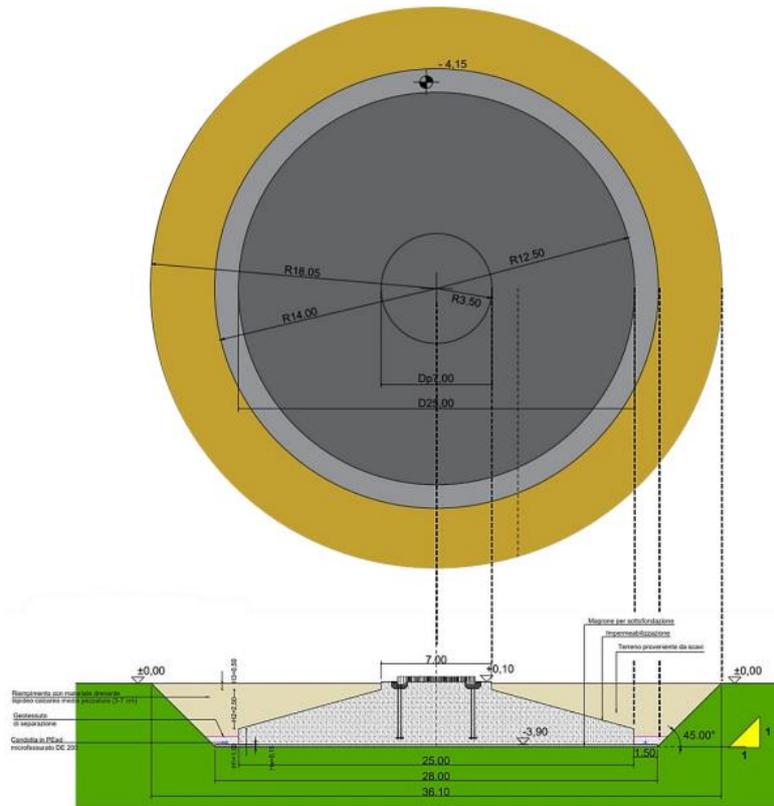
4: Pianta e vista della fondazione tipo dell'aerogeneratore
